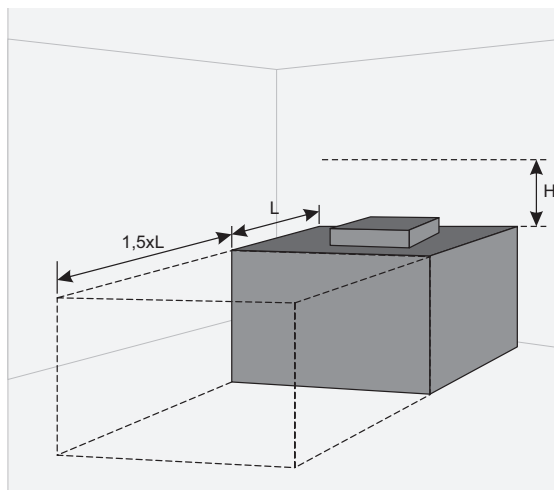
Min. Abstand für Türöffnung - 1,5xL; Min. Abstand für Öffnung des Schaltkastens - H > 400 mm.
